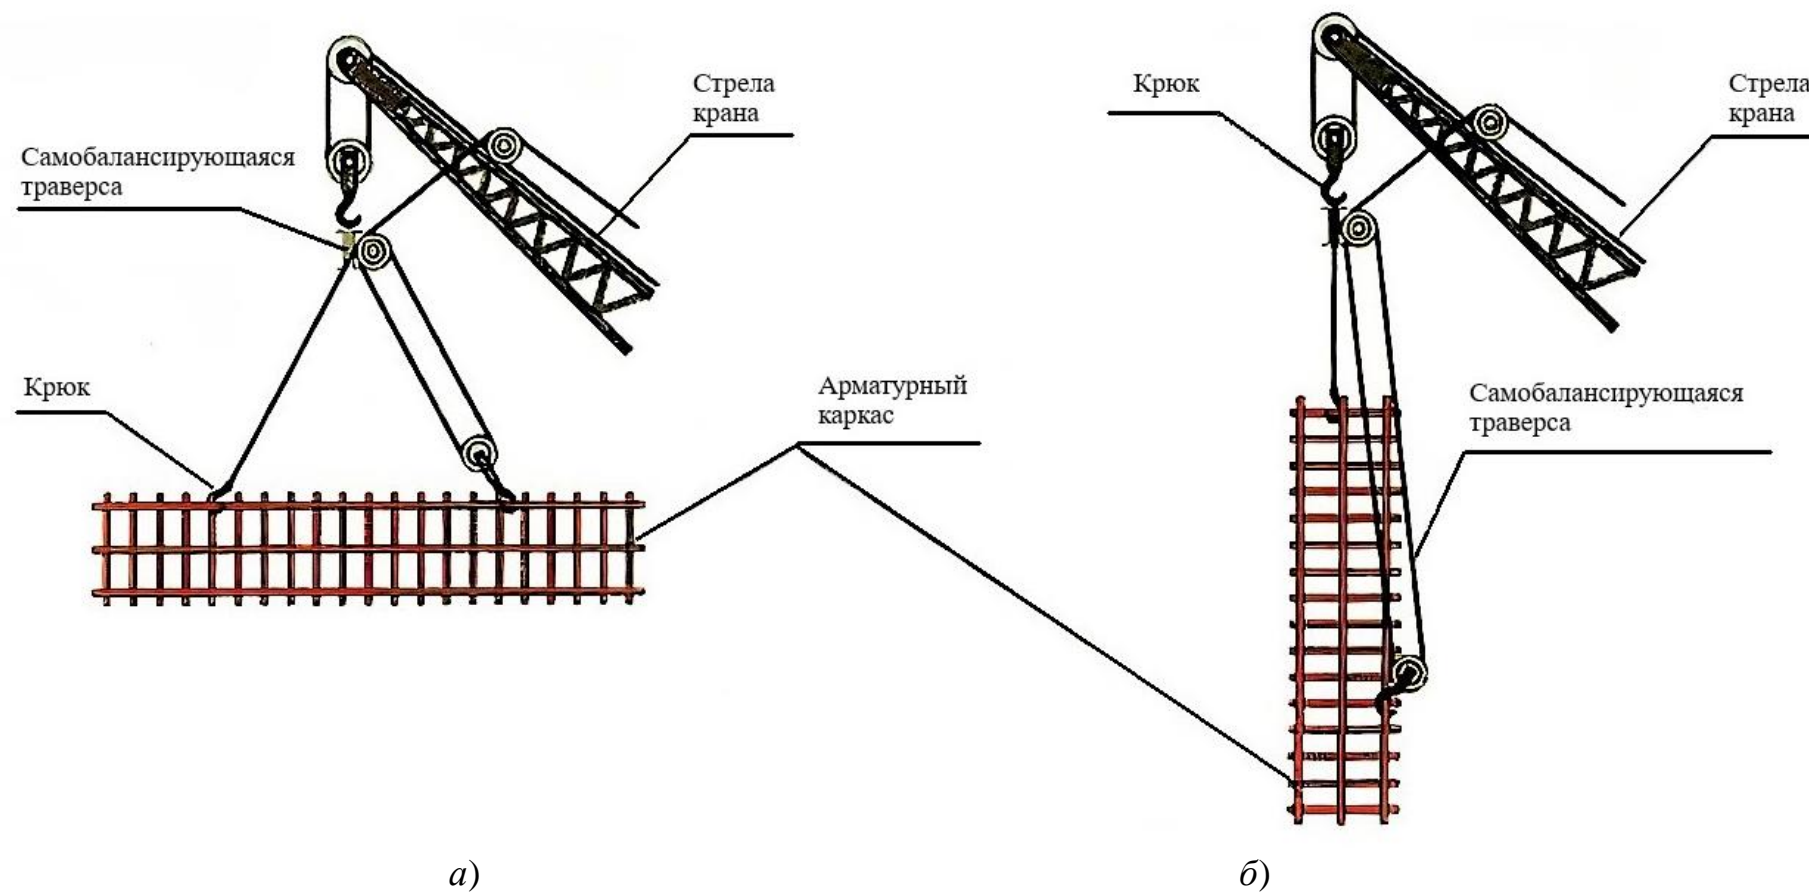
Установка пространственных арматурных каркасов краном:
